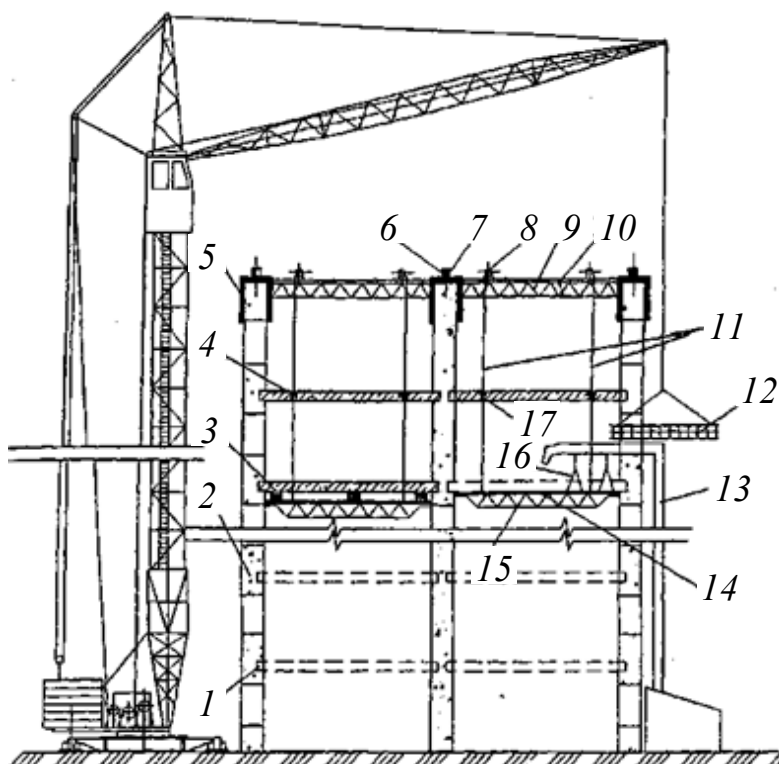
Бетонирование междуэтажных перекрытий методом «сверху вниз»:
